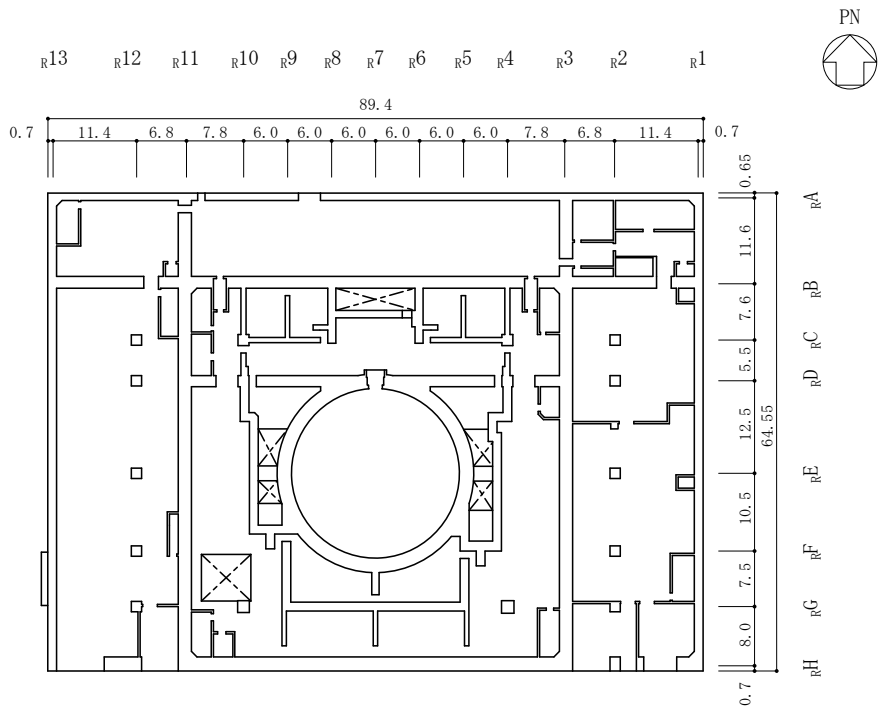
(2) 原子炉建物の概略平面図 (EL 8.8m)
